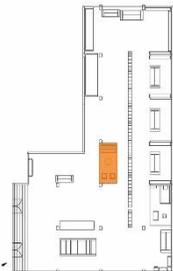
13 Layout Titik Lampu Ruang Pamer I
